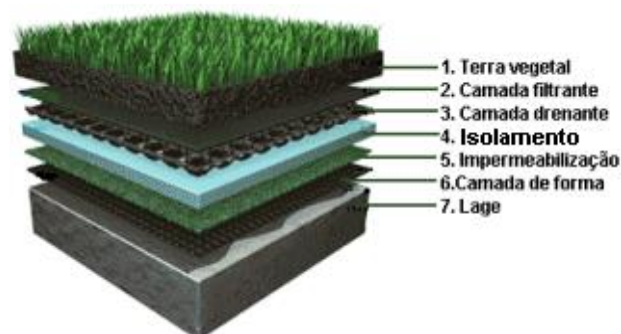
Corte construtivo Tipo, (Fonte: <http://www.planetacad.com>, 2013)
